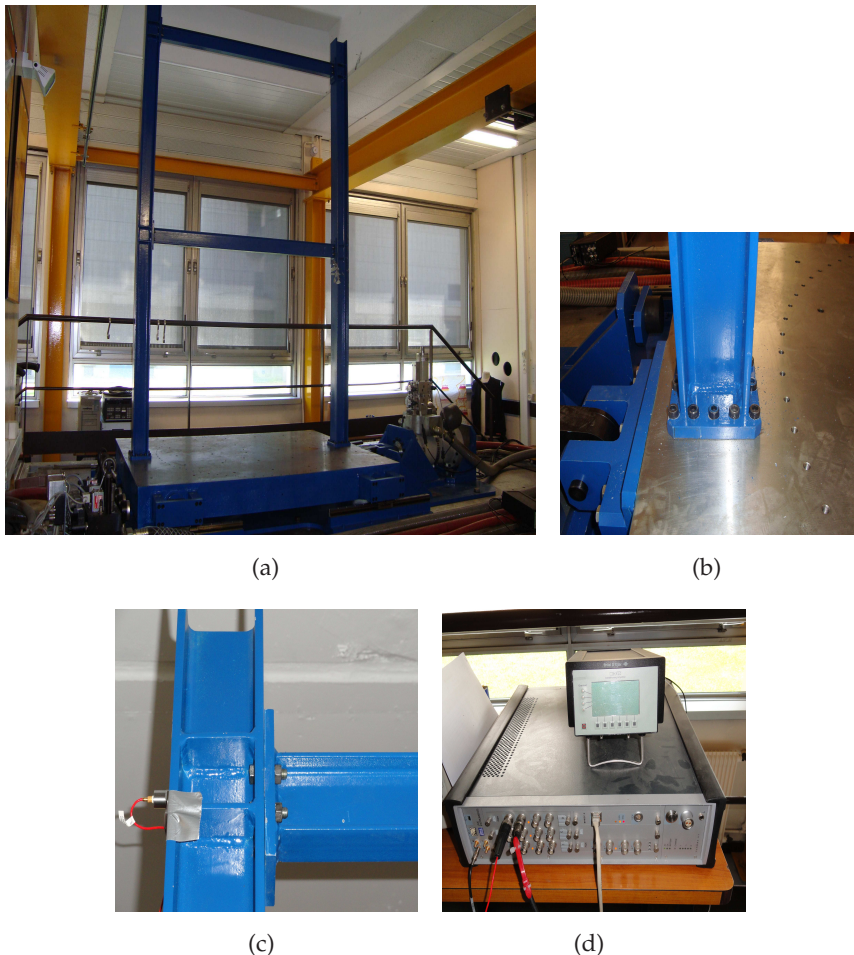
(a) Arrangement d'essai ; (b) Assemblage d'un pied de poteau ; (c) Un accéléromètre ; (d) Un système d'acquisition de données (en bas) et un dispositif utilisé pour mesurer les déplacements (en haut)
